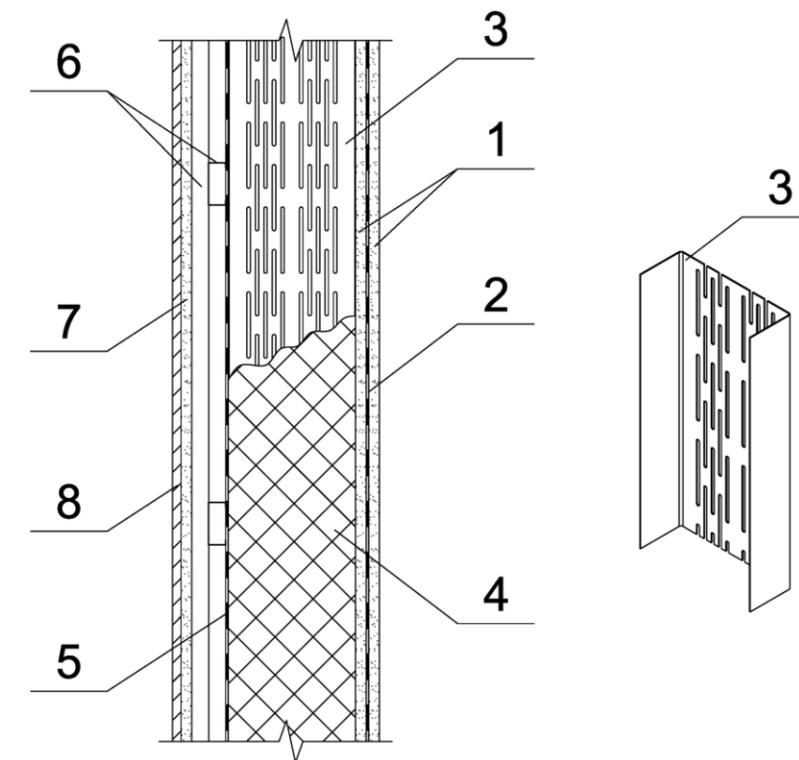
Принципиальное решение каркасно-обшивных стен (КОС). 1- внутренняя обшивка два слоя, 2- пароизоляция, 3- стойка стальной термопрофиль, 4- утеплитель, 5- гидроветрозащита, 6- контрообрешетка из стальных гнутых профилей, 7- наружная облицовка.
